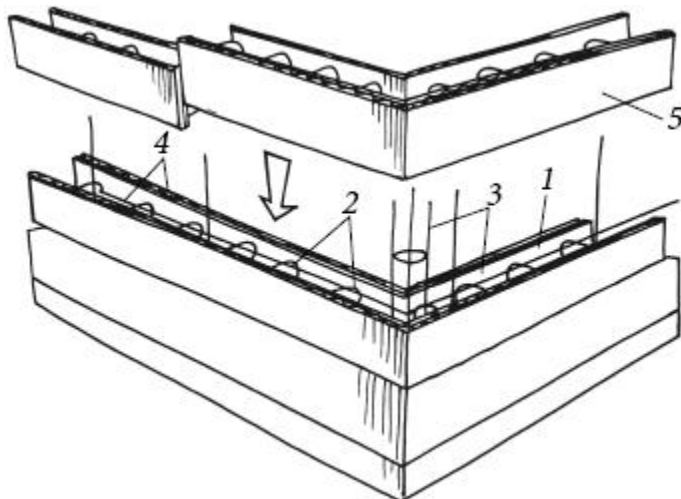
Возведение стены по технологии несъемной опалубки: 1) блоки пенополистирола (опалубка); 2) вставки (распорные перемычки в блоках); 3) арматура; 4) пустоты для заливки бетона; 5) следующий ряд блоков
